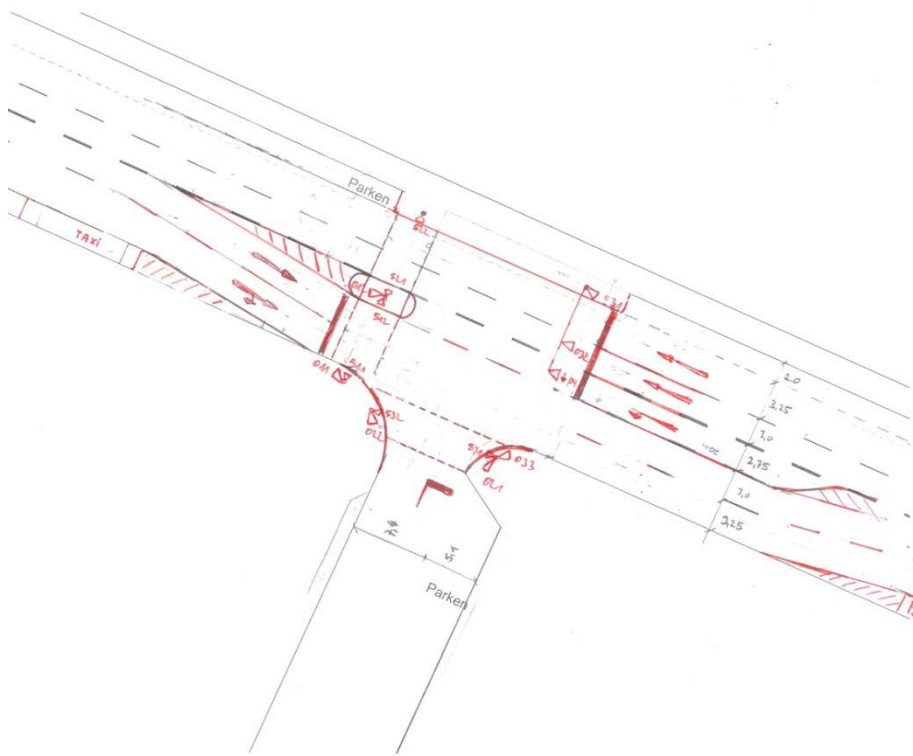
Signallageplan Sonnenstraße / Landwehrstraße mit Ausfahrtmöglichkeit nach Norden
